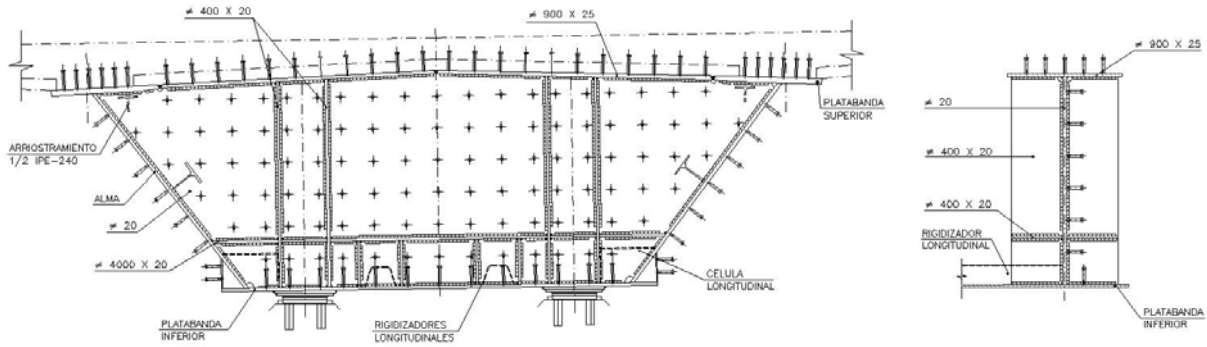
Diafragma sobre estribos; a) Alzado; b) Sección
